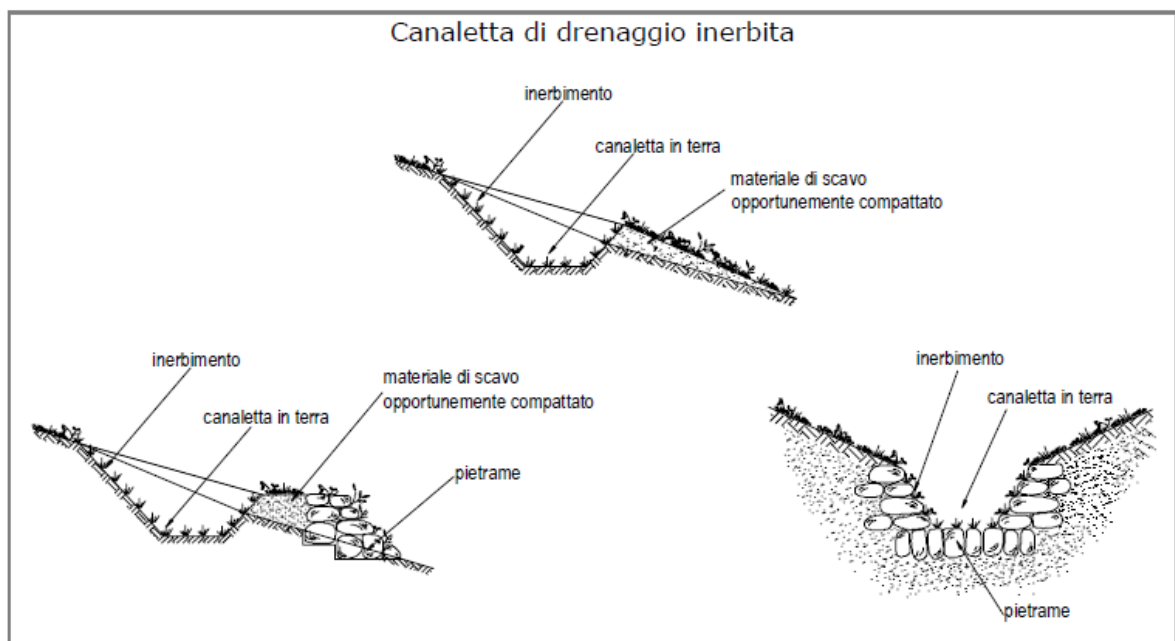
Schema di una canaletta di drenaggio inerbita – PGUAP
